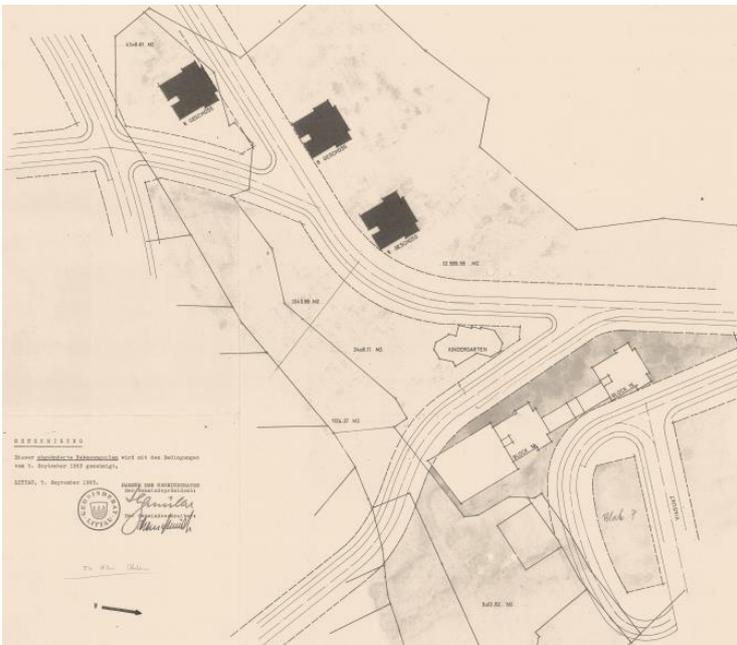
Bebauungsplan B 1 Fluhmühle (Plan 2)
